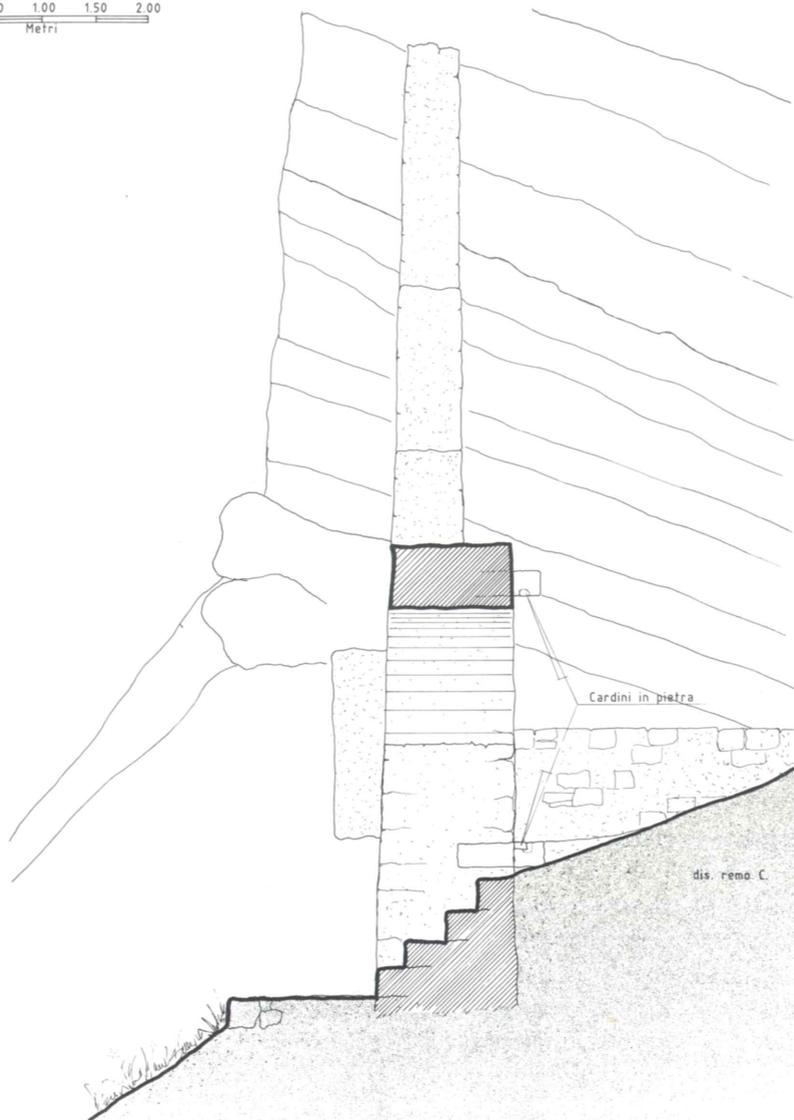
Sezione trasversale del muro sull'asse della porta.
